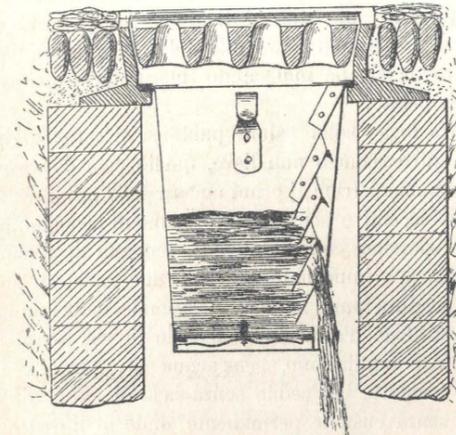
Pozzetto Poli-Sifone (Sezione trasversale per strade piane).
